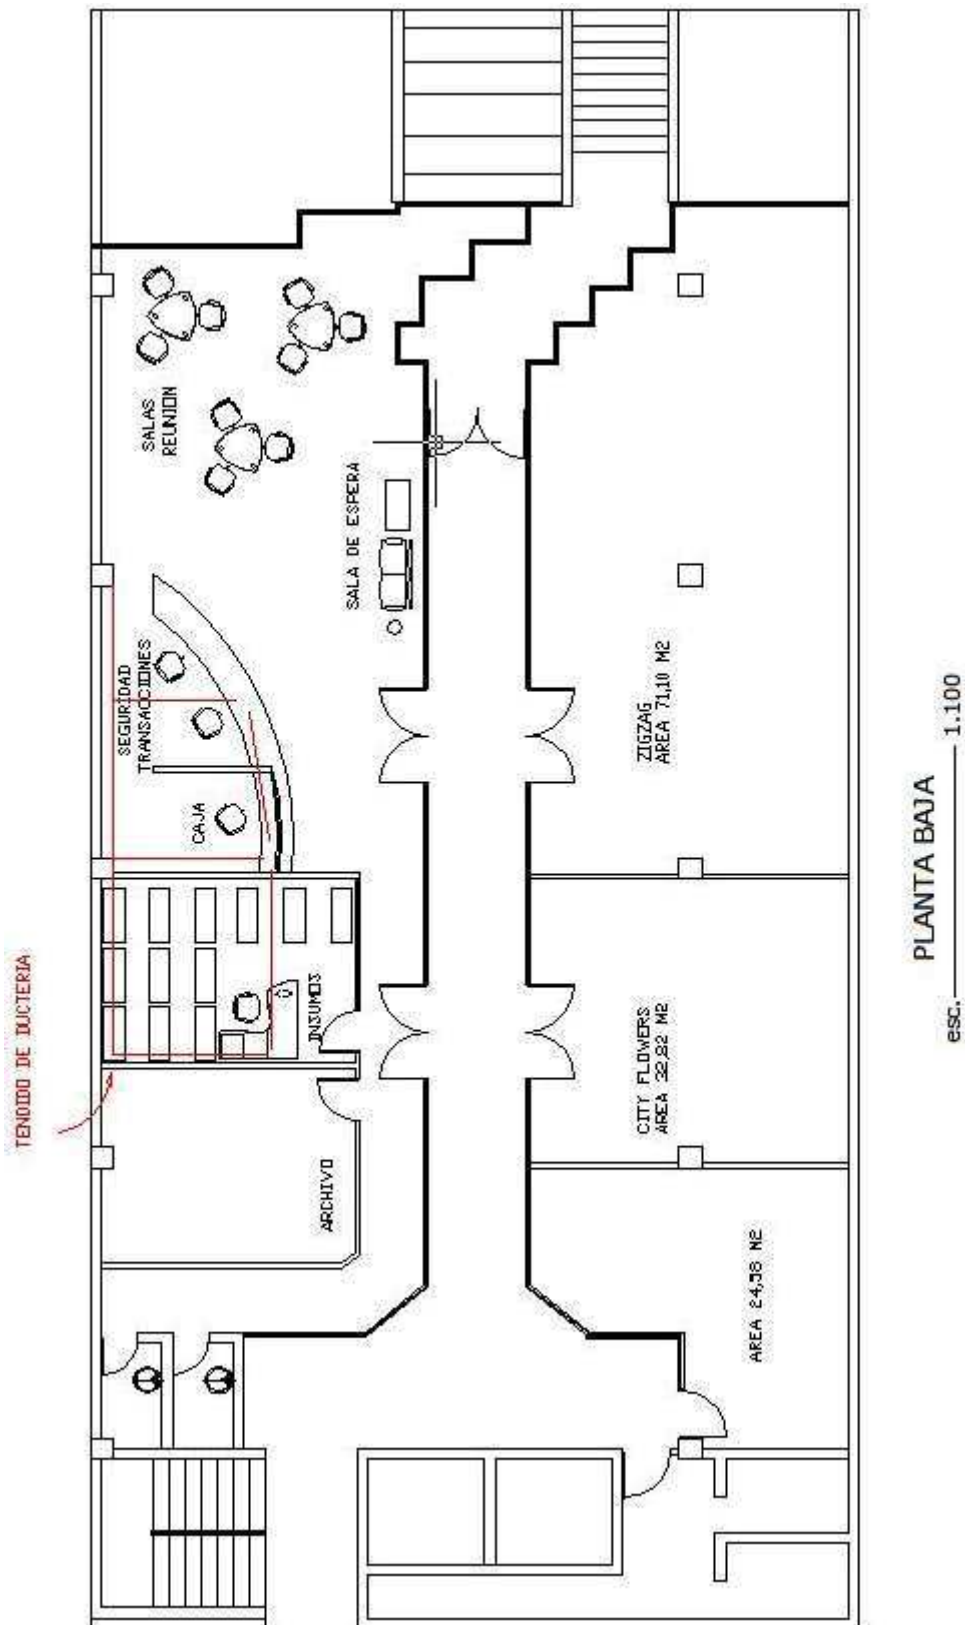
Distribución ductería propuesta Planta Baja.
